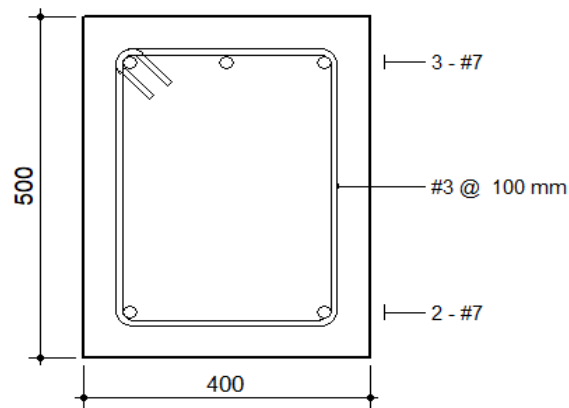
Sección de viga perimetral plantas 1, 2, 3 y 4. Fuente: Propia.
